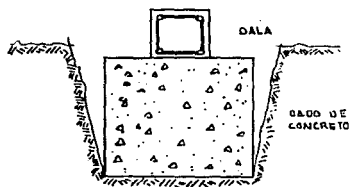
CIMENTACION DE CONCRETO SIMPLE.
